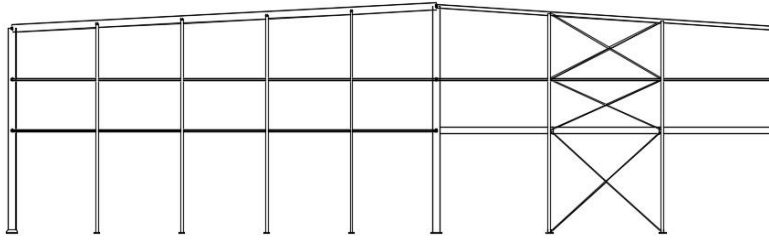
Pórtico de fachada F. (Fuente: Cype 3D)
